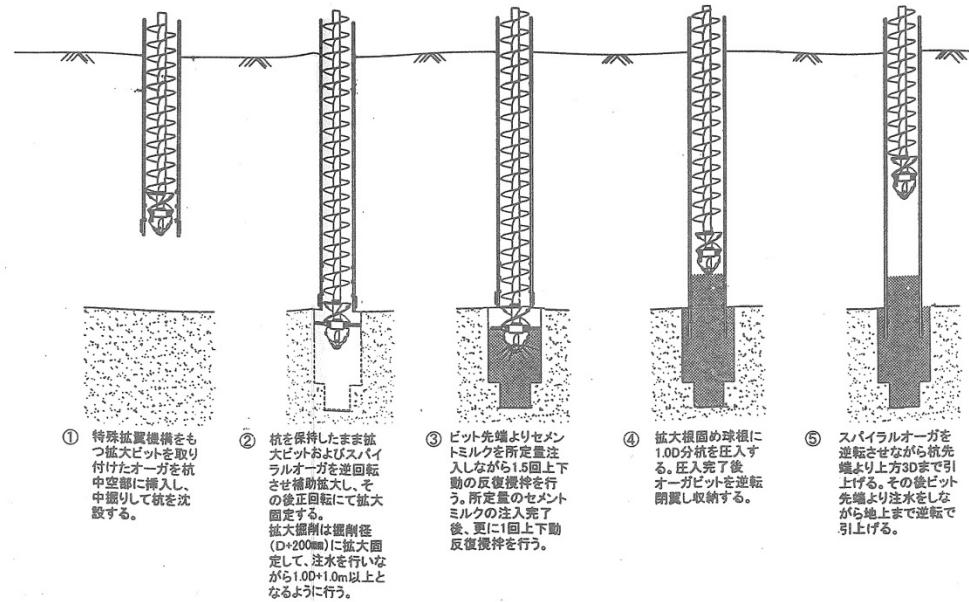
(b) T B S 工法(RBタイプ)の施工手順
